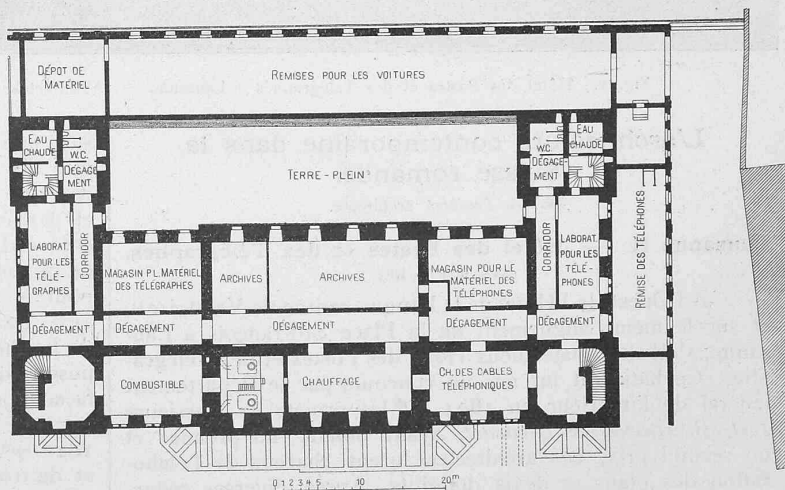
Plan du sous-sol. — Echelle 1 : 800.
